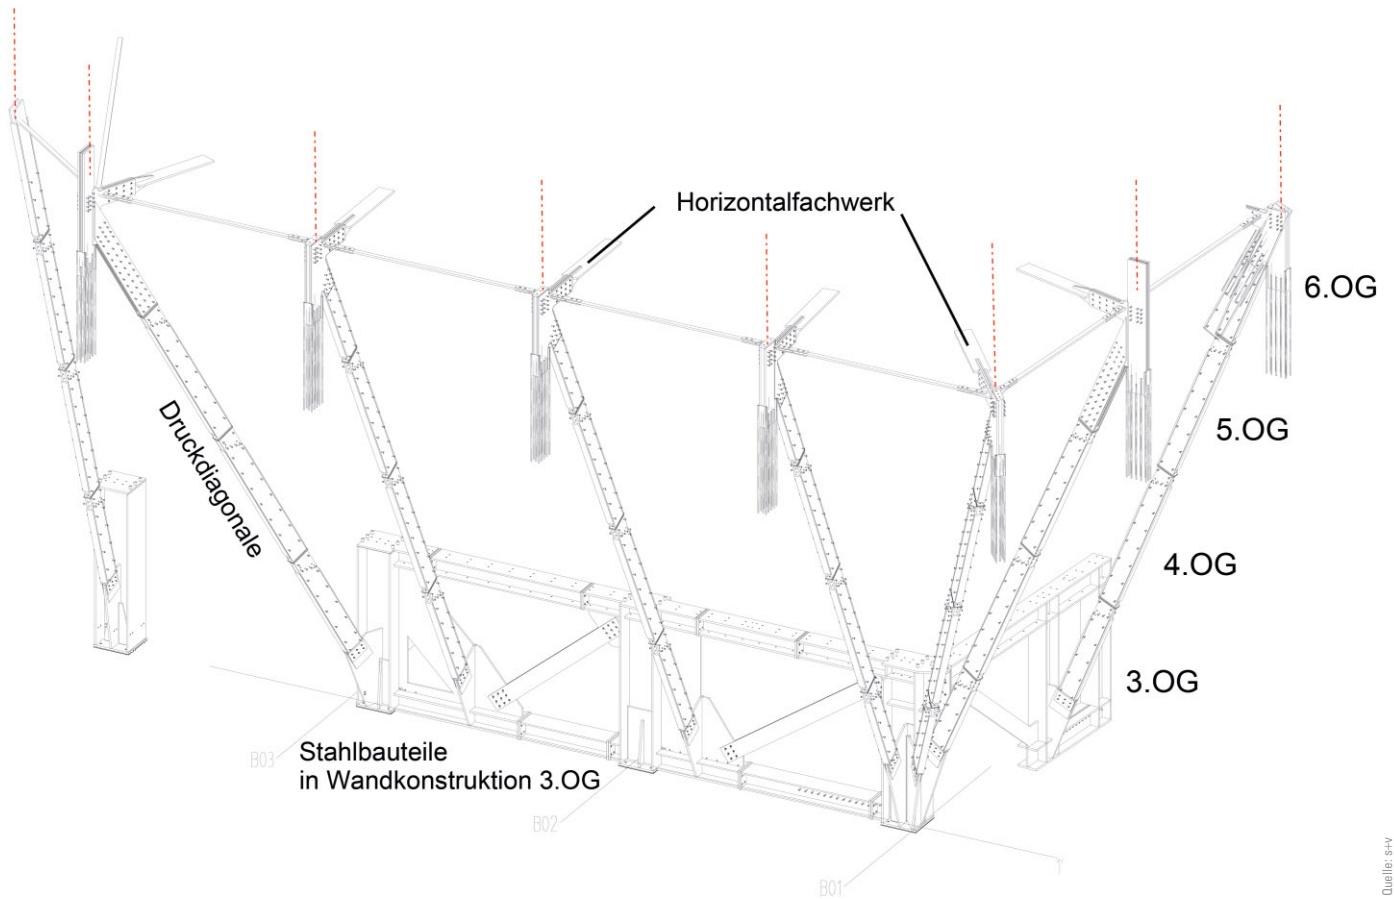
Wandartiger Träger, Druckdiagonale und Anschlüsse an Horizontalfachwerk im 6. OG
